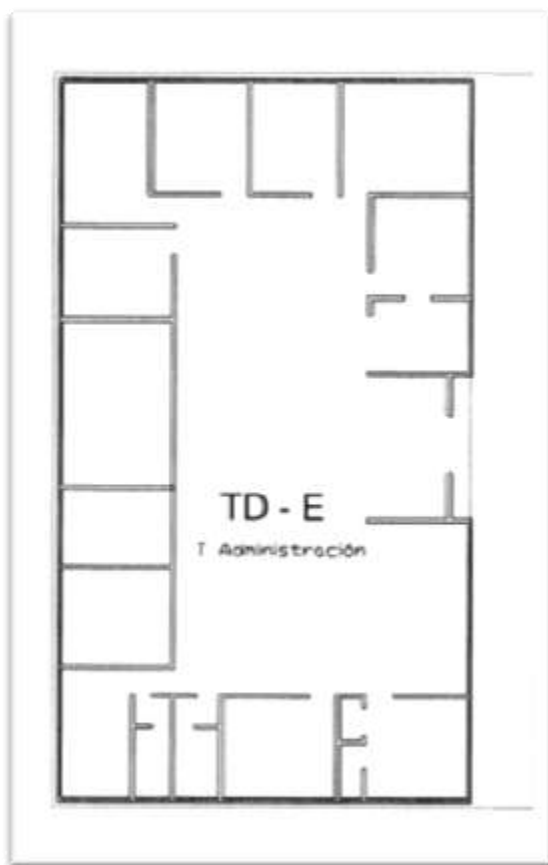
PLANTA EDIFICIO DE ADMINISTRACIÓN.
